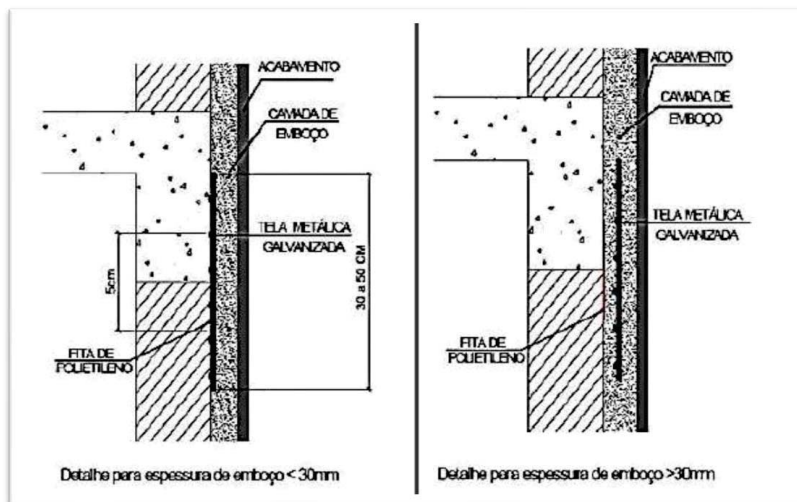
Posicionamento das telas metálicas na camada de recuperação.
